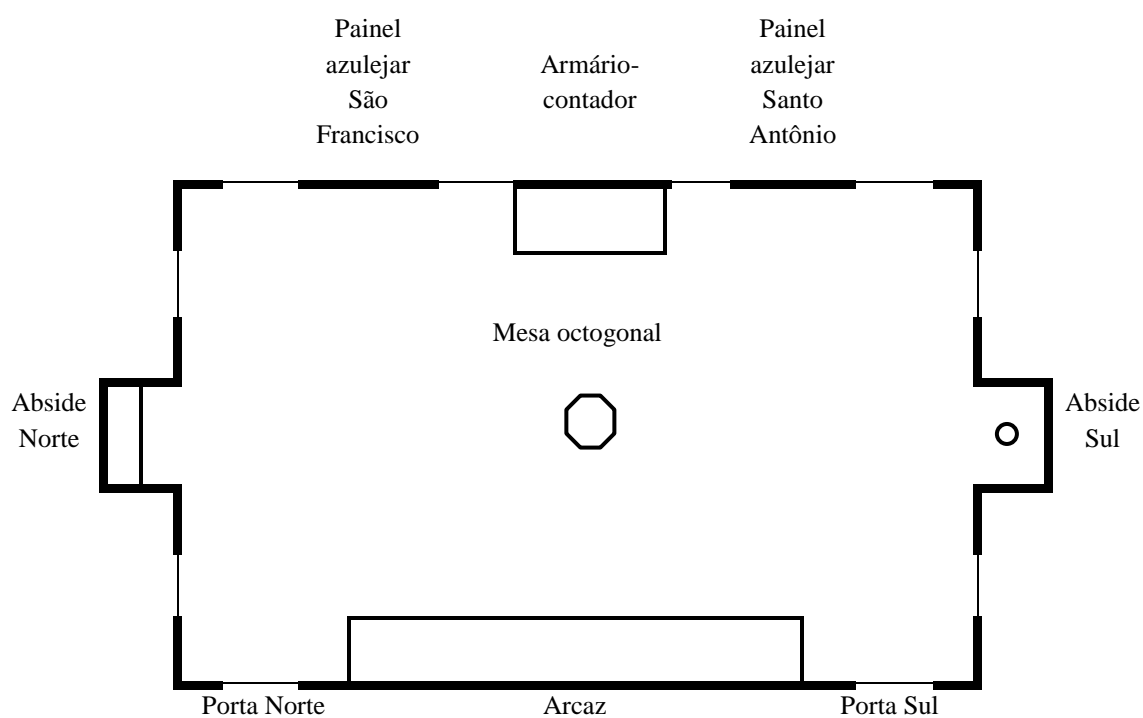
Planta da sacristia com indicação da localização das suas peças. Esquema do autor.
